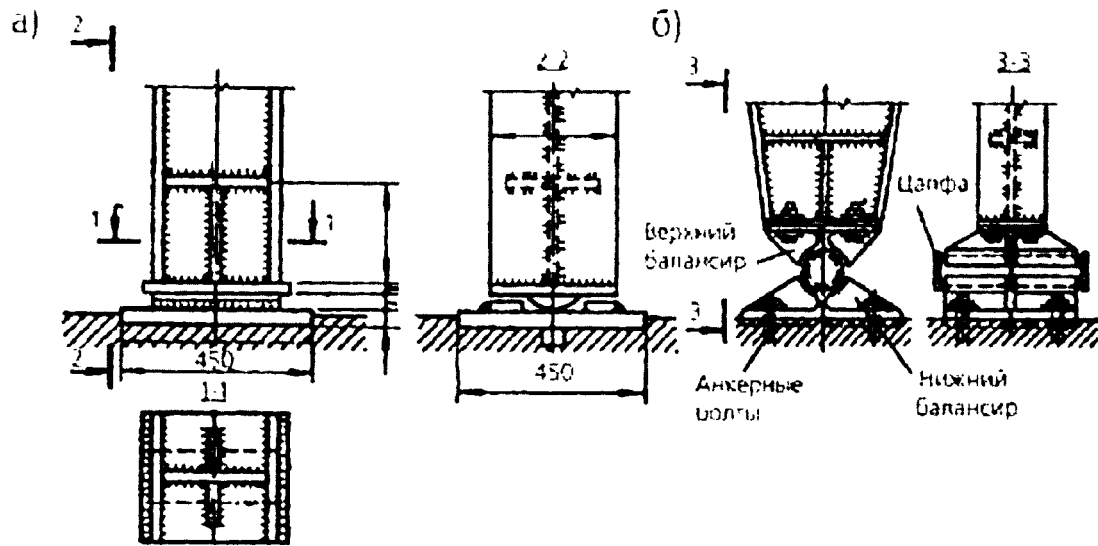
Узлы опирания сплошных рам на фундамент: а - плитный шарнир; б - цилиндрический шарнир
